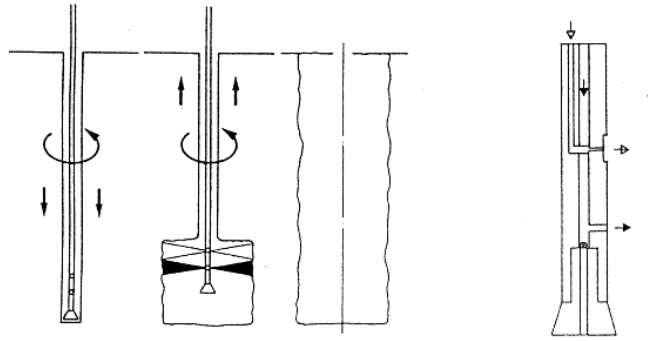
Jet Grouting - água e calda de cimento - Tipo 2 [20]
